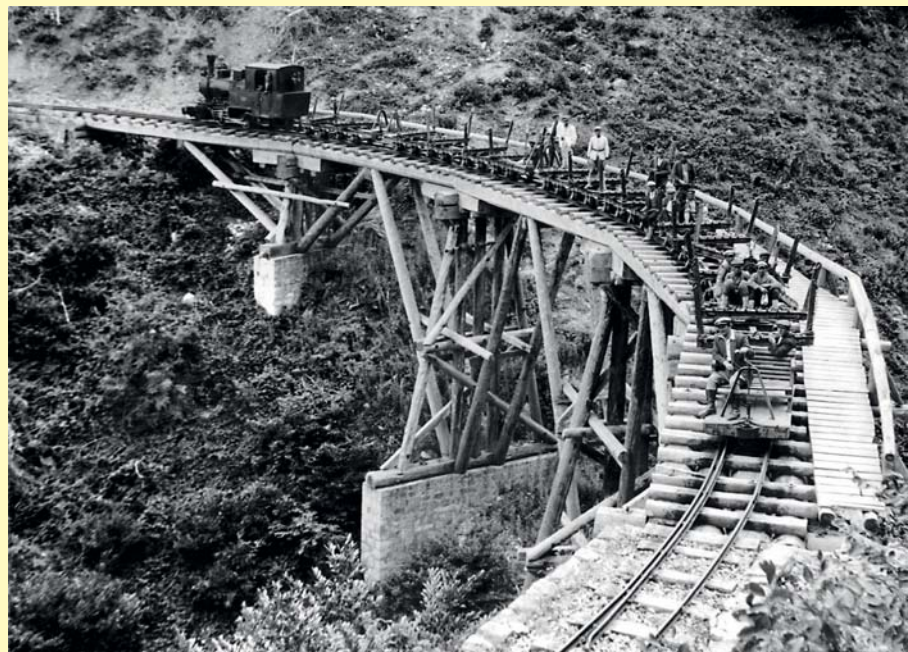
Zerbrechlich aussehende Trestlebrücken wurden zur Überquerung kleinerer Einschnitte errichtet.
